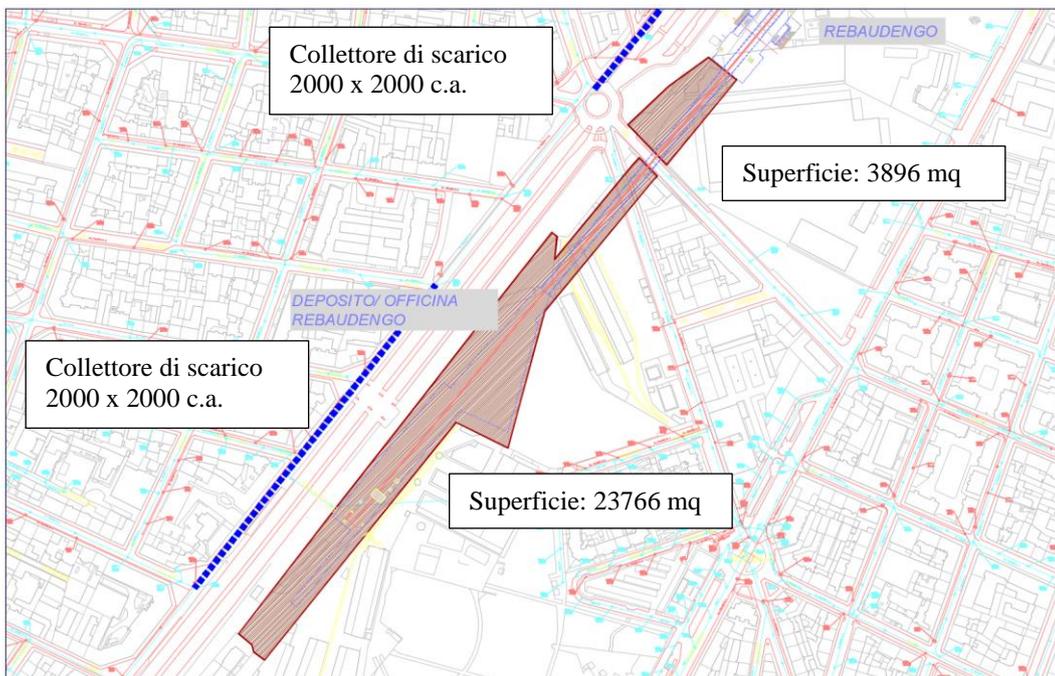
Aree di cantiere – Deposito/officina Rebaudengo – FASE 2
